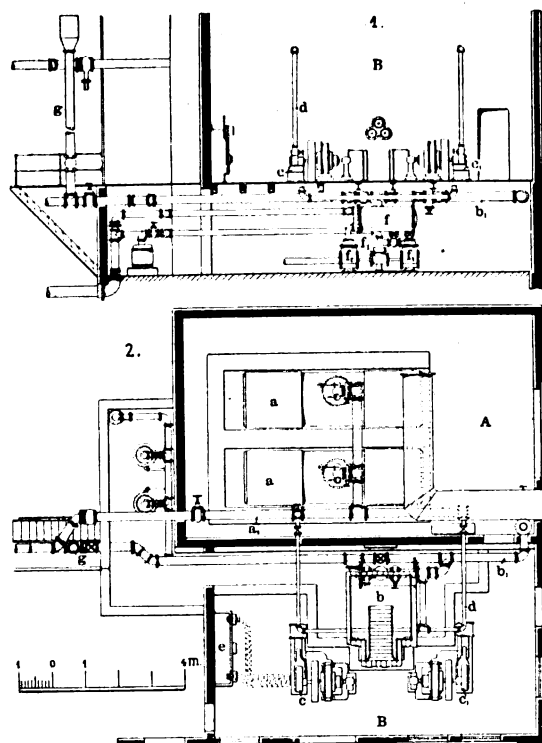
Z. A.: Die neue Maschinen-Werkstätte der Harrisburg Foundry & Machine Works in Harrisburg.
